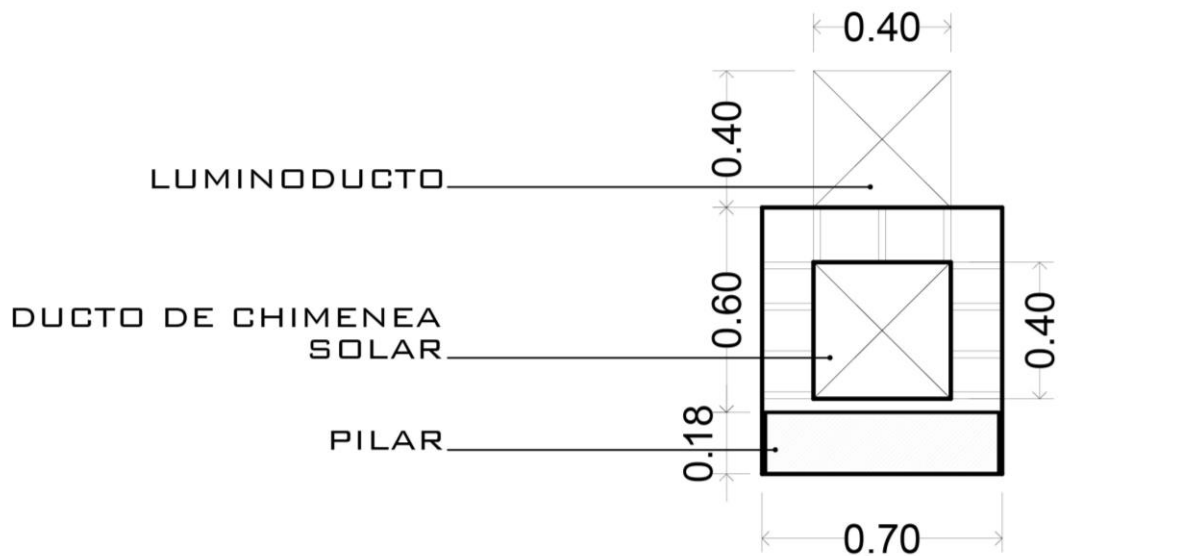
Detalle Constructivo de Huevo de Entrada de Aire.
